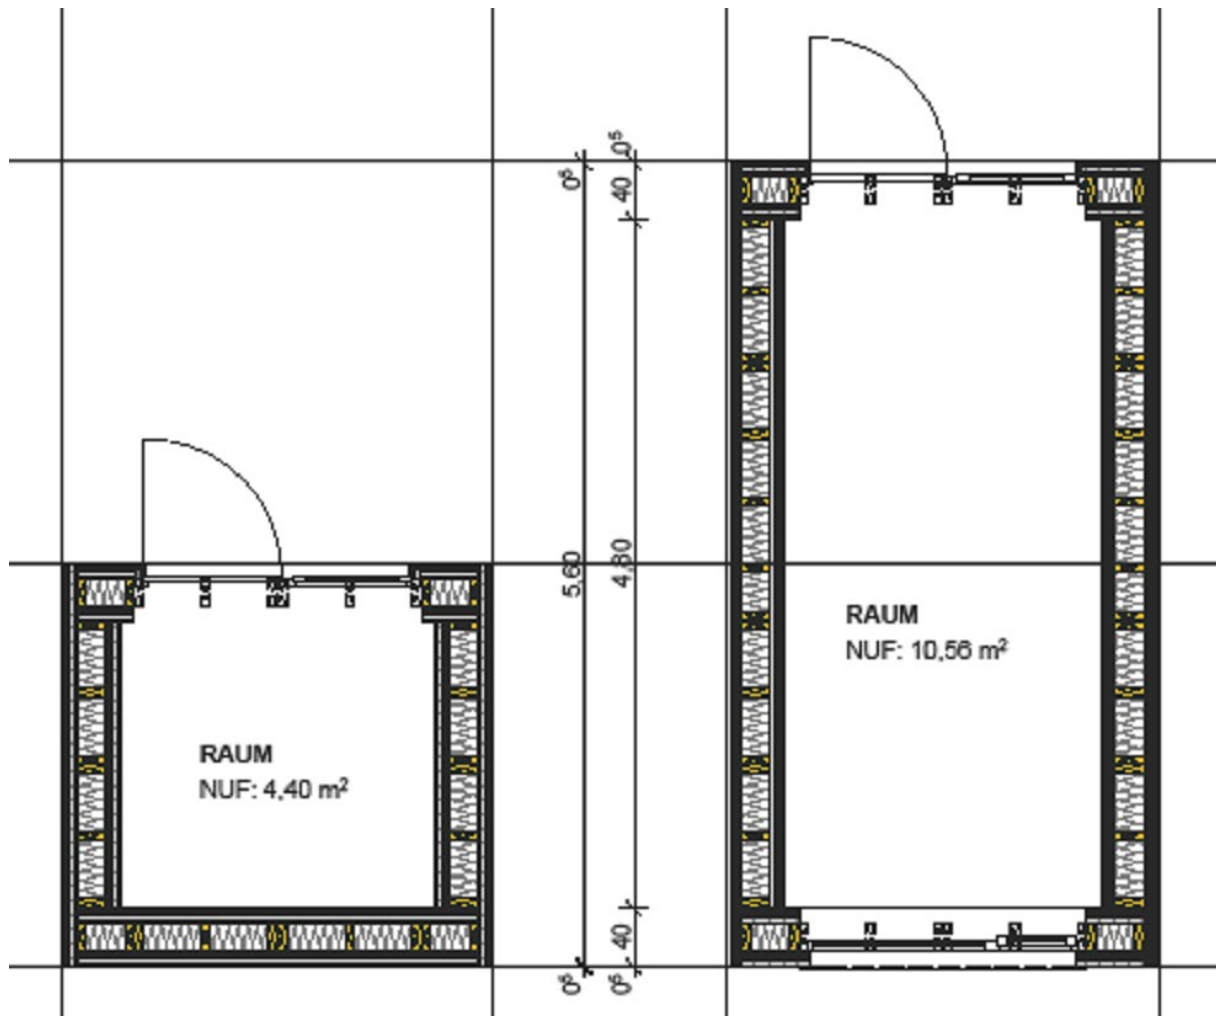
Grundrisse von Einfachmodulen (eigene Darstellung)
